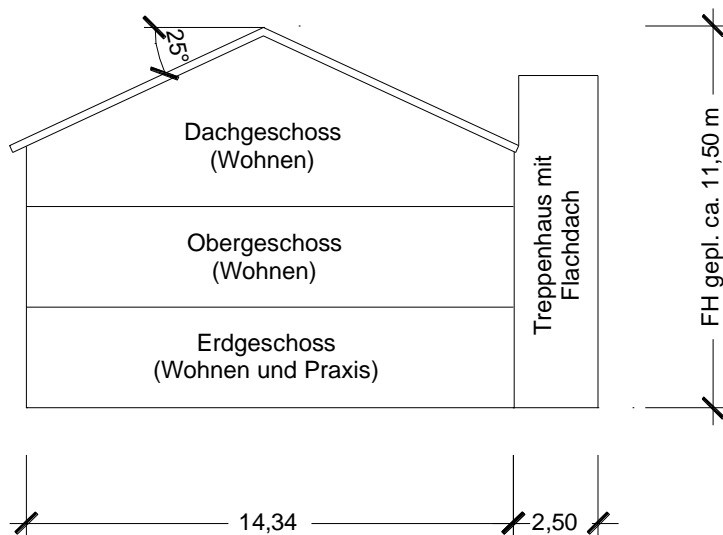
Systemschnitt (Vorentwurf) des Vorhabens „Bachgaublick“ mit Darstellung der geplanten Nutzungen, eigene Darstellung InfraPro, Datenquelle: Bärenhaus GmbH, Neubrandenburg, 2021; Hauptdach mit max. 25° Dachneigung, im Bereich des Treppenhauses als untergeordnetes Bauteil auch Flachdach zulässig
